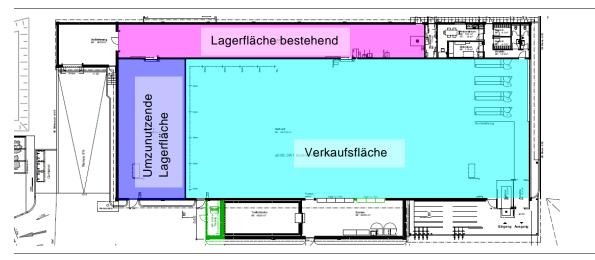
Grundriss bestehendes Gebäude
